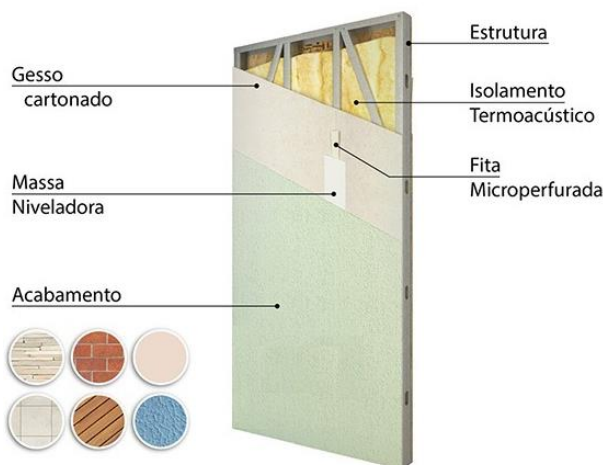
Detalhe construtivo de paredes interiores LSF, [88].
